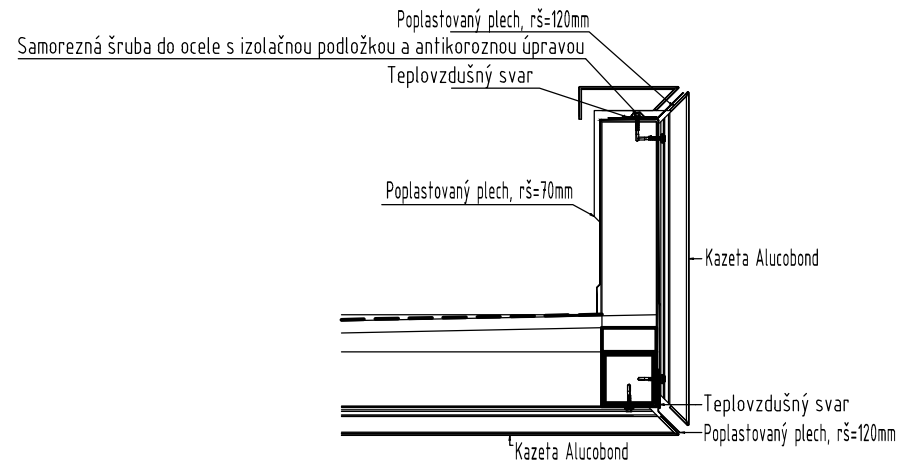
### DETAIL REZ STRIEŠKOU NAD HLAVNÝMI VSTUPMI
